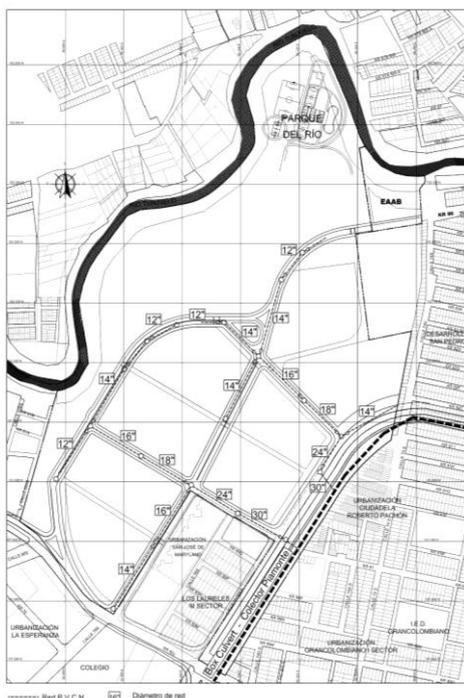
Planteamiento Urbano del Plan Parcial – Redes de Alcantarillado Pluvial
